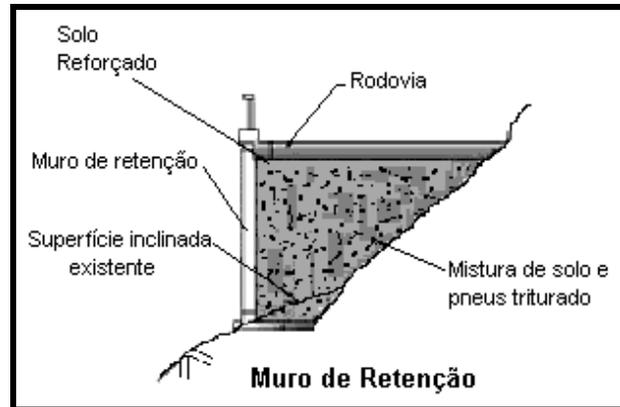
Material de enchimento na parte posterior de estruturas de retenção.
